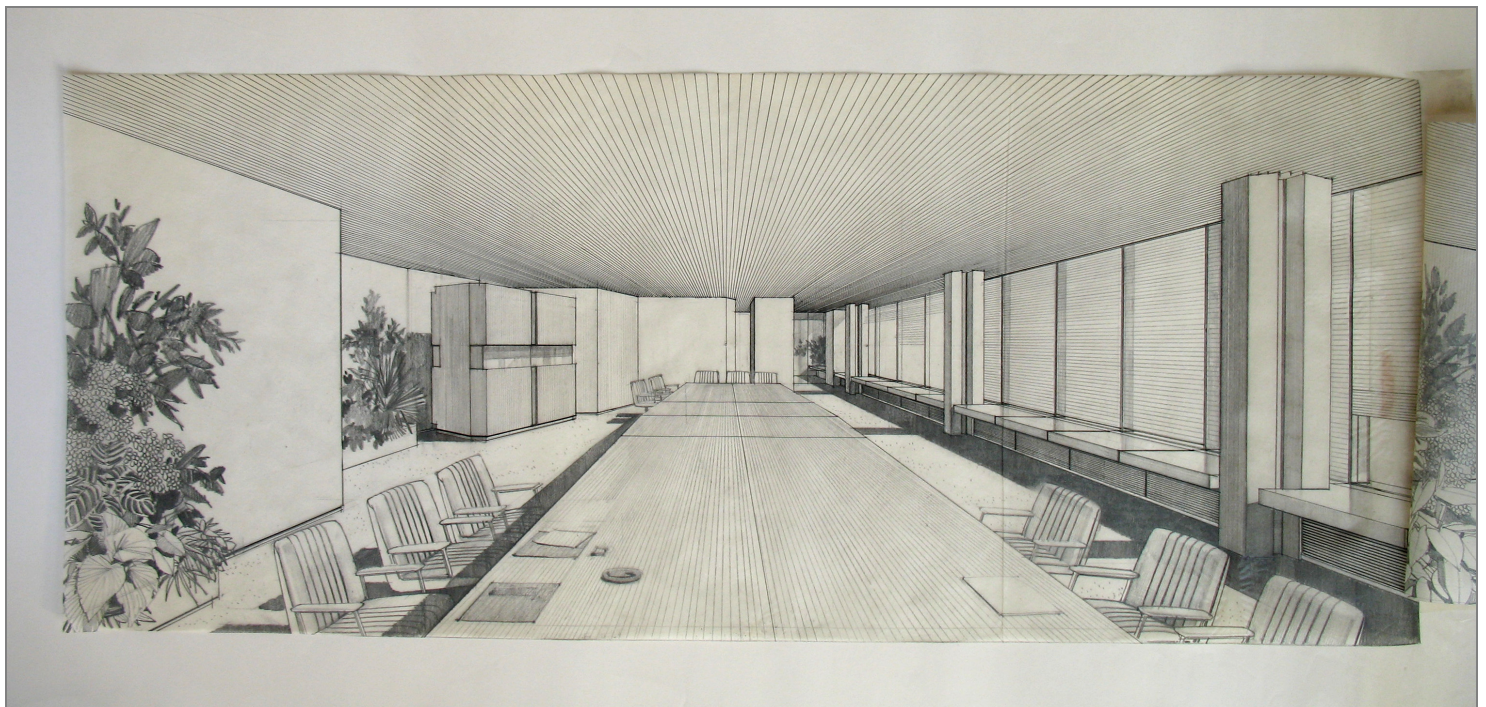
vista prospettica - sala riunioni (fonte CSAC , archivio n. 70-3)
